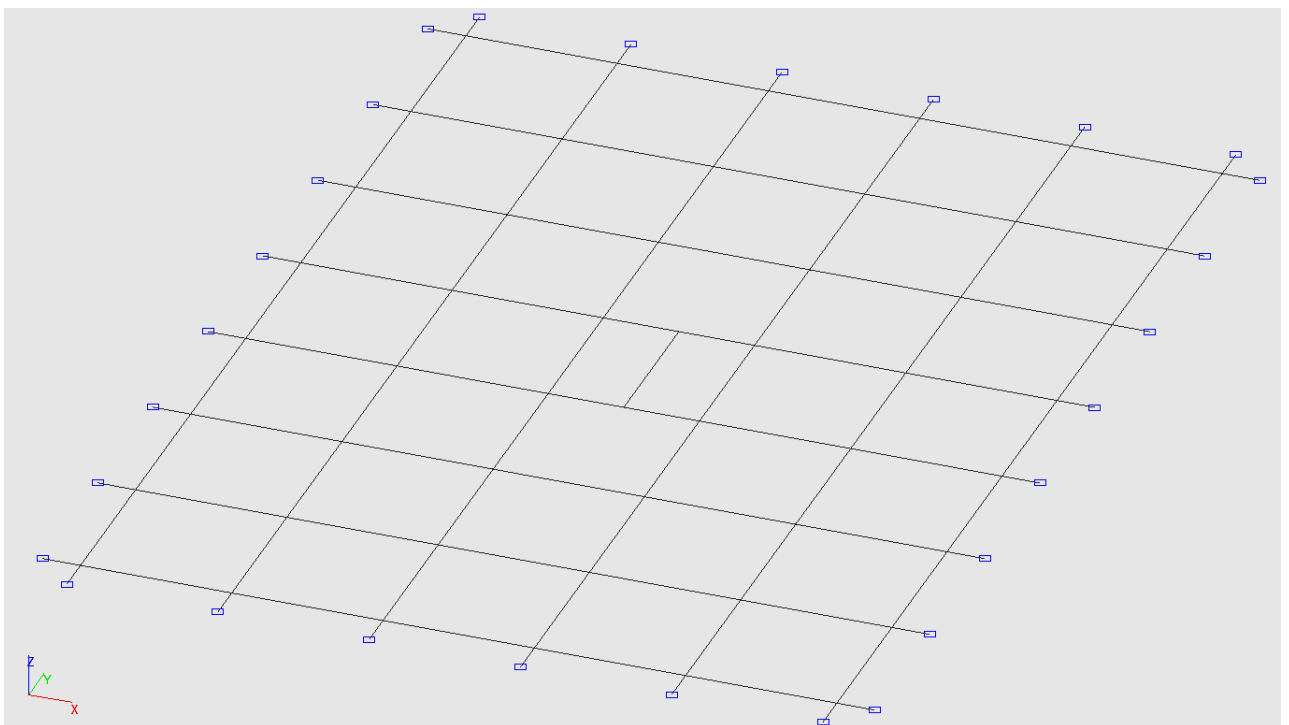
Расчетная схема плиты перекрытия, заданная объемными телами
